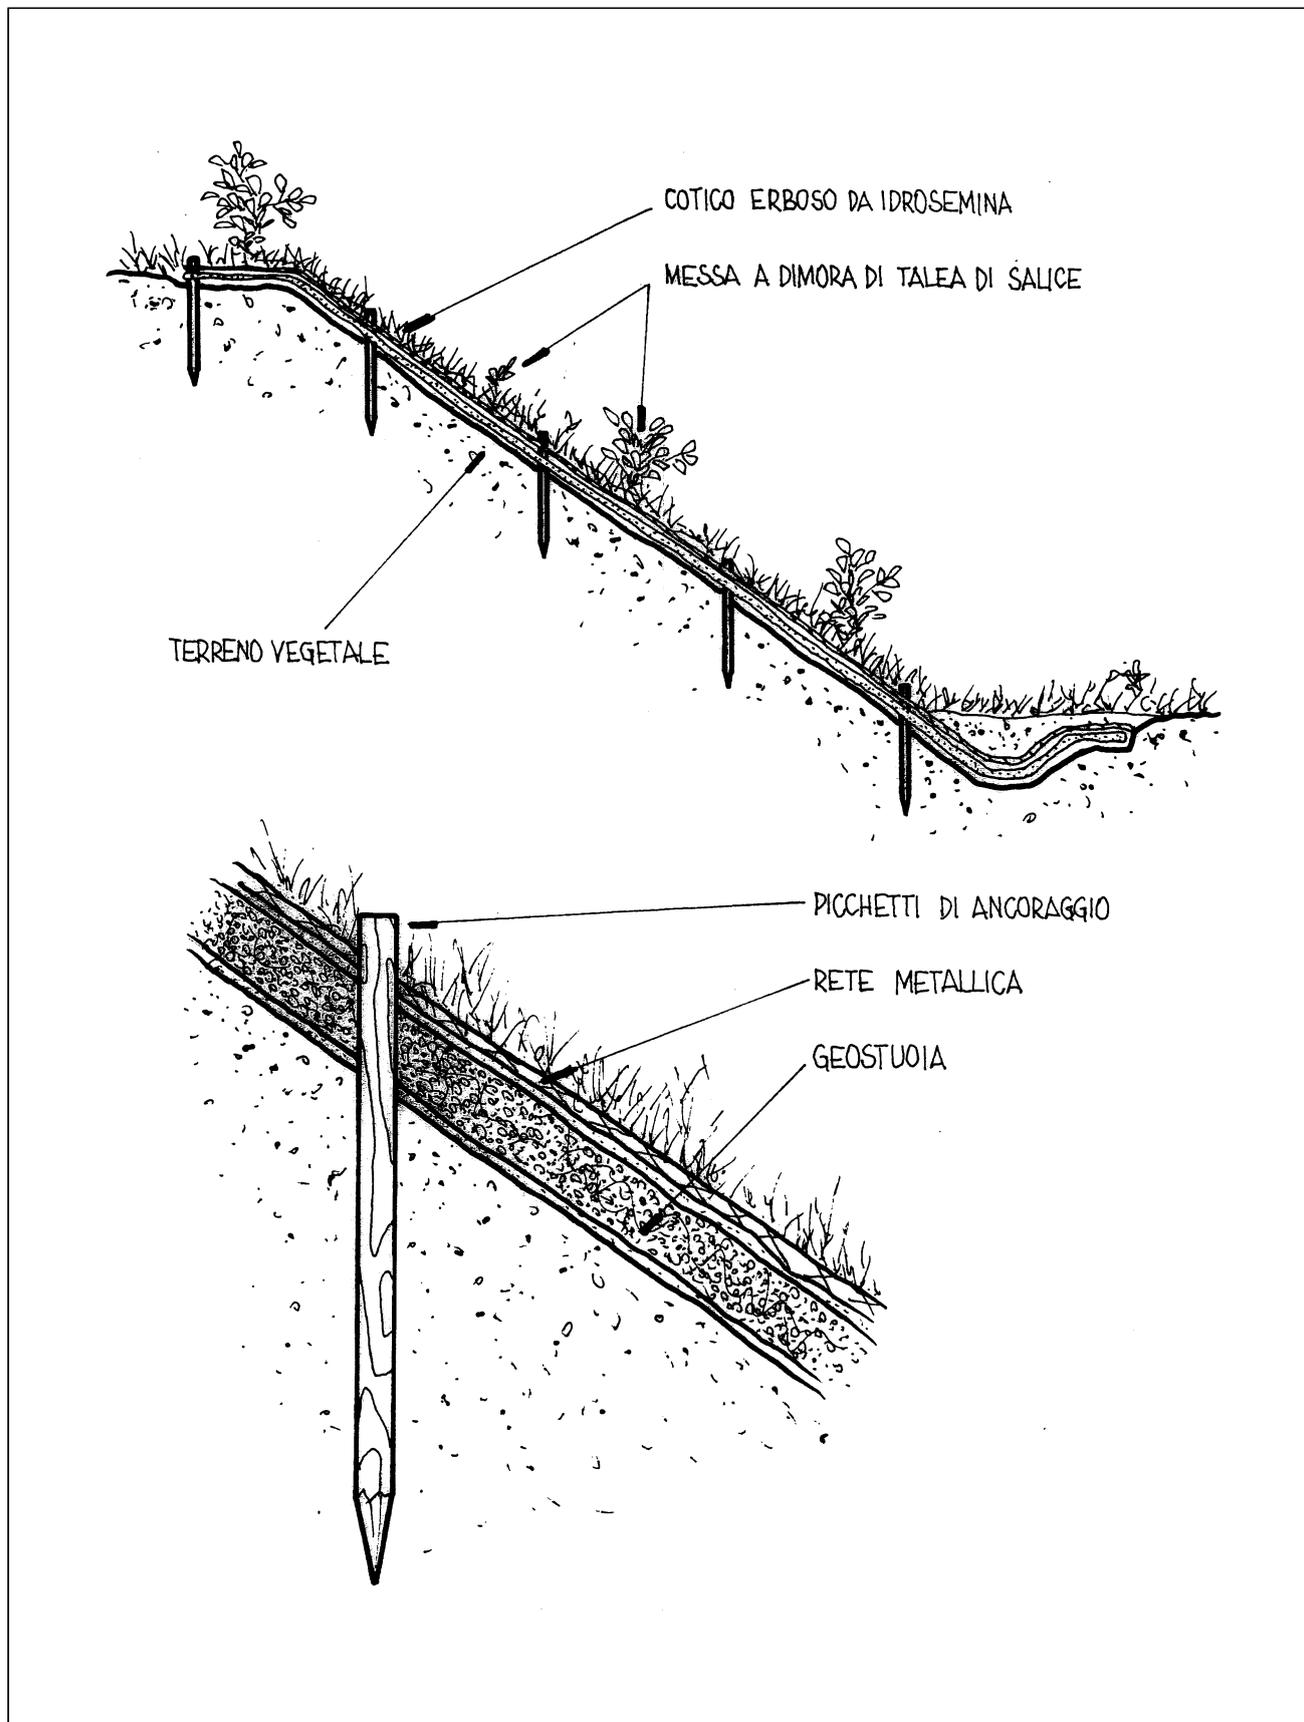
PROTEZIONE DI VERSANTI CON ELEMENTI ANTIEROSIVI E INERBIMENTO
